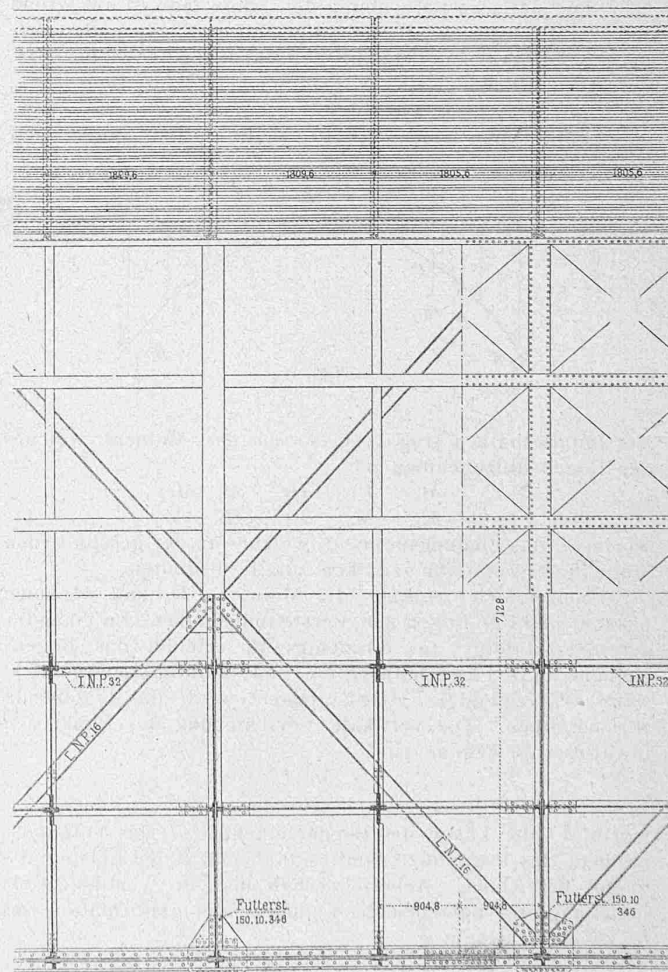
Grundriss der Fahrbahn 1:75.
